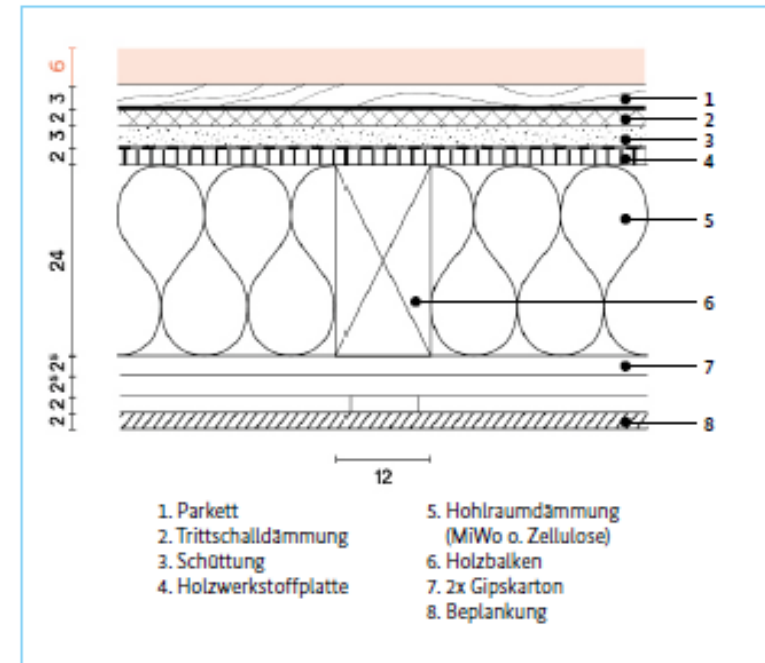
Abweichende Bauweise – Holzbau Geschossdecke
